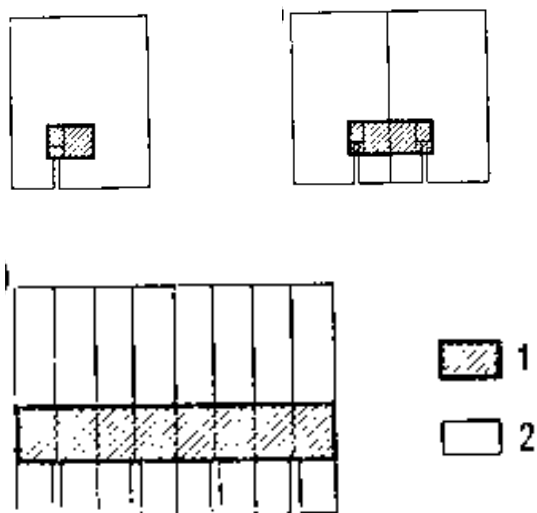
Типы малоэтажных жилых домов: А-одноквартирный; Б – двухквартирный; В-многоквартирный (блокированный); 1-план дома; 2-
